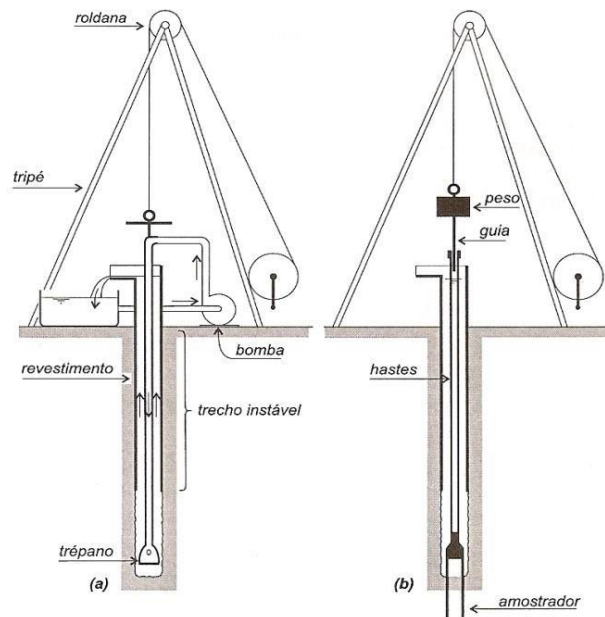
Etapas na execução de sondagem a percussão: (a) avanço de sondagem por desagregação e lavagem; (b) ensaio de penetração dinâmica (SPT).
